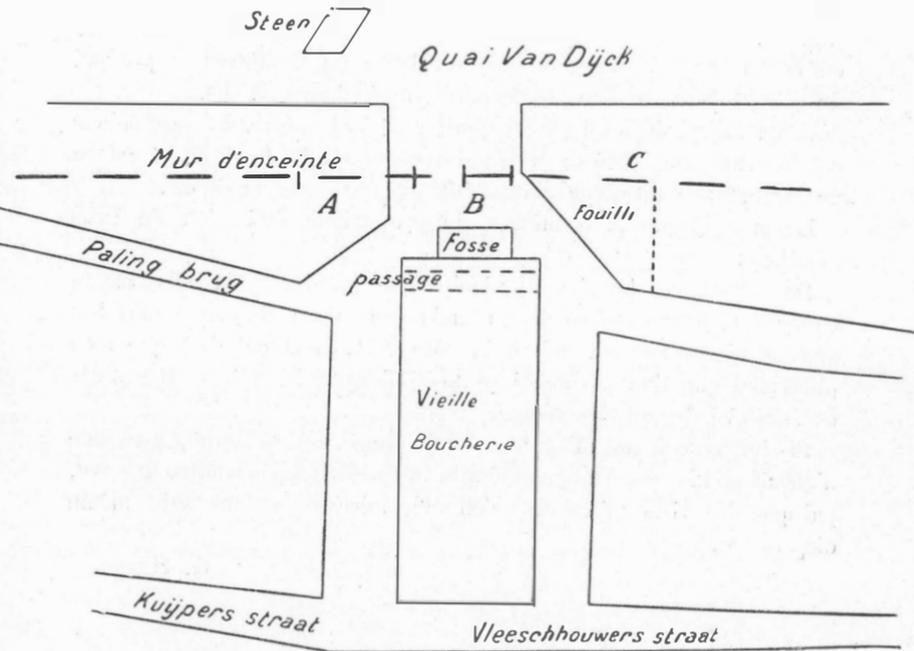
PLAN DE SITUATION DU MUR ET DE LA FOUILLE.
